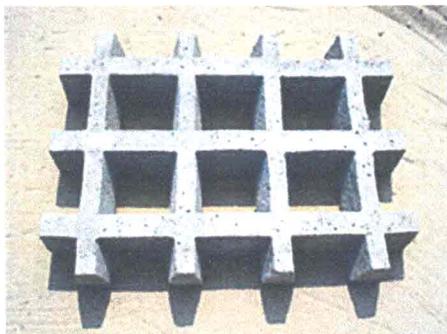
Modelos de peças feitas de concreto para pavimentação de áreas.
